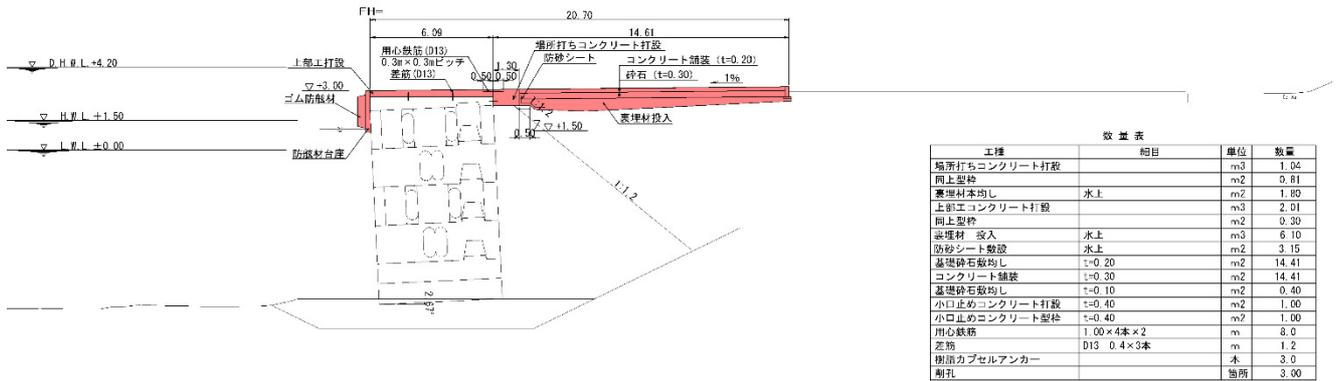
No.23 常陸那珂港区_南ふ頭地区 C 岸壁 (-7.5m) の断面図 (復旧後)
